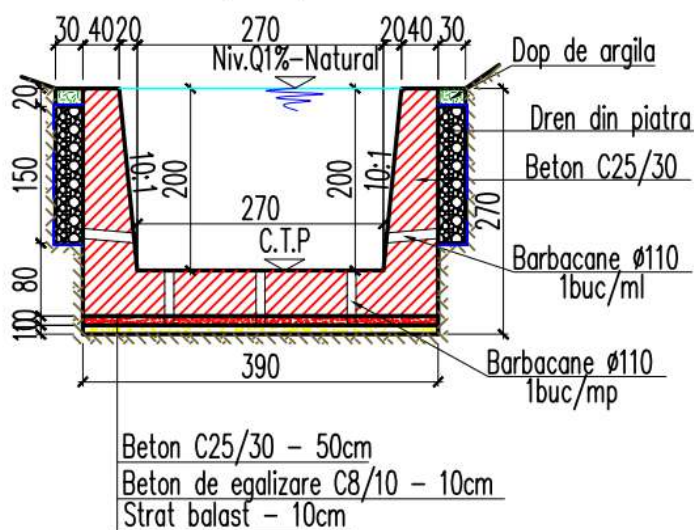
ST1/2 Casetă din beton (B= 2.70 m, H=2.00 m)
